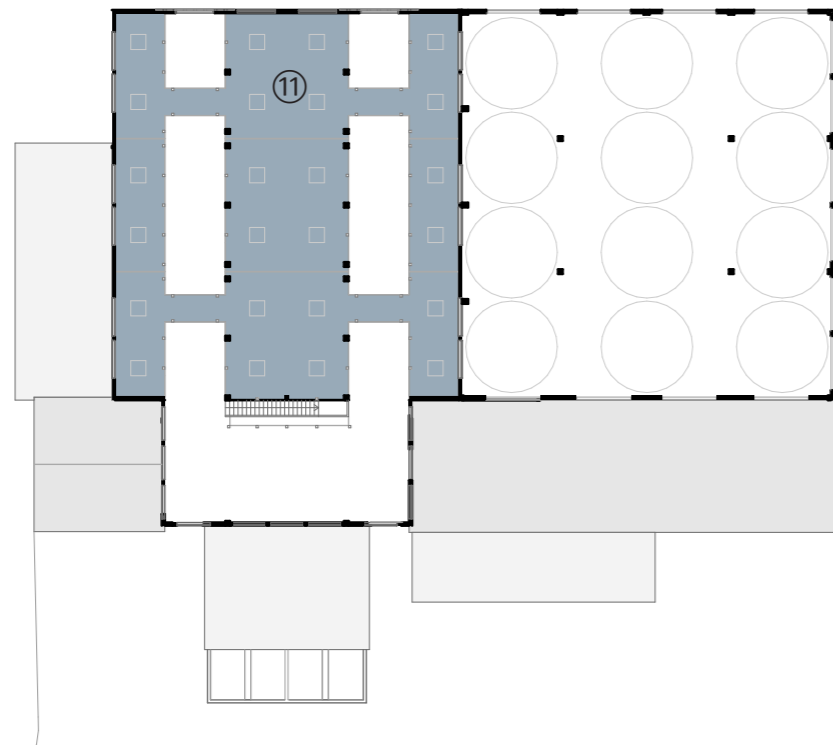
Grundriss OG, Oberste Ebene
